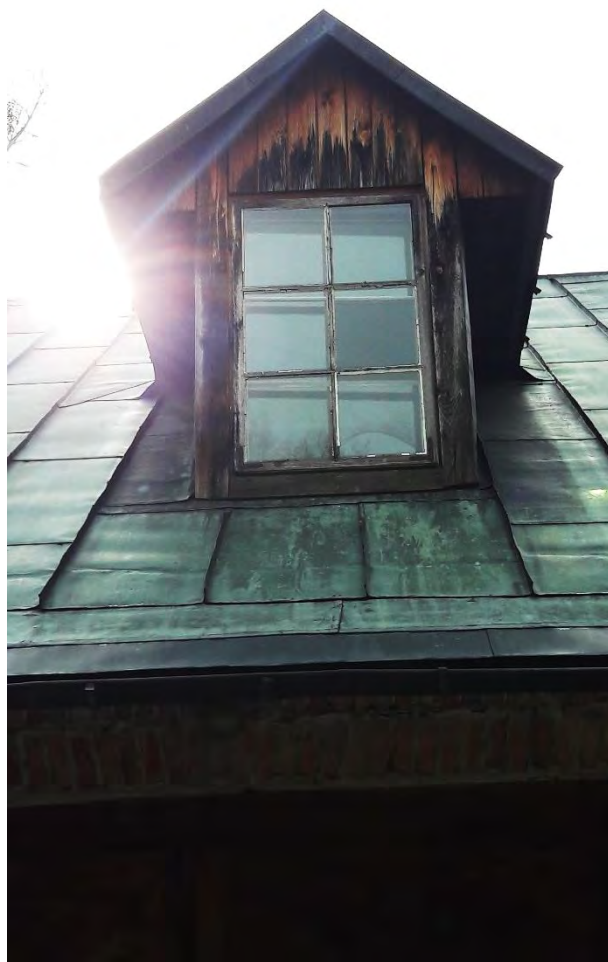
Elewacja frontowa - widok okna skrzynkowego
